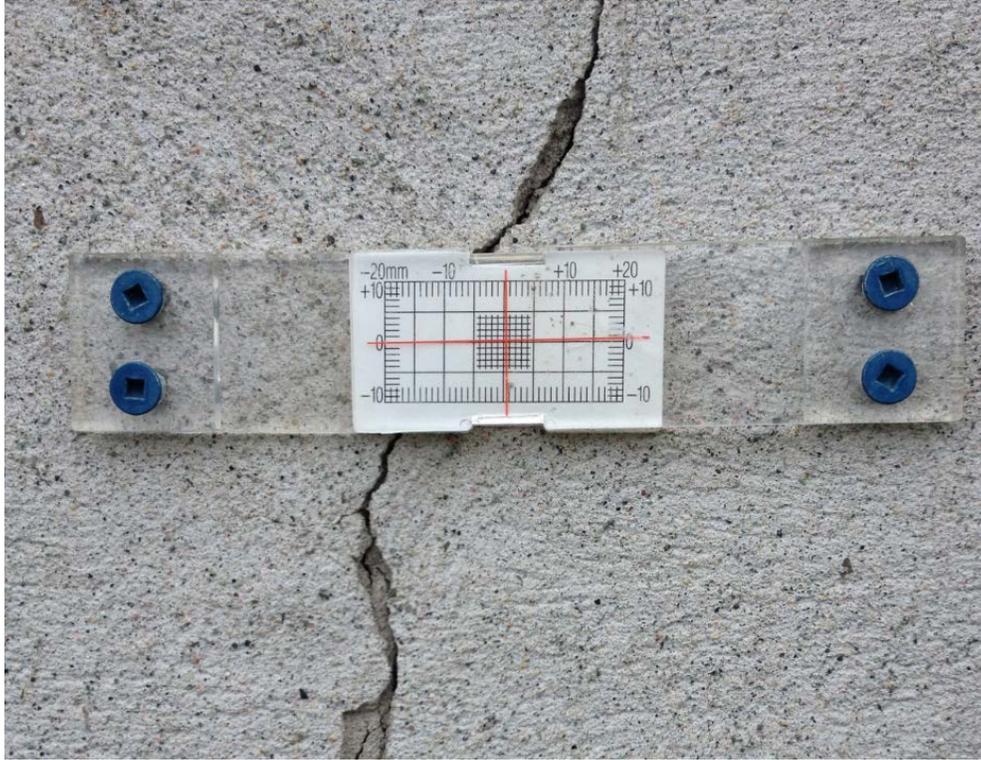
Fissuromètre installé sur le mur d'un bâtiment dans la Ville de Malartic
